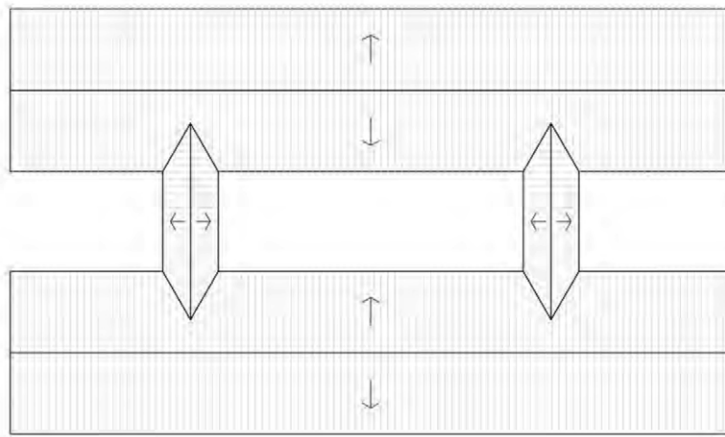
Planimetría del bloque en H situado en el barrio de San Cristóbal de los Ángeles de Madrid. Alzado y secciones. Fuente: Sánchez-Guevara (2015)
